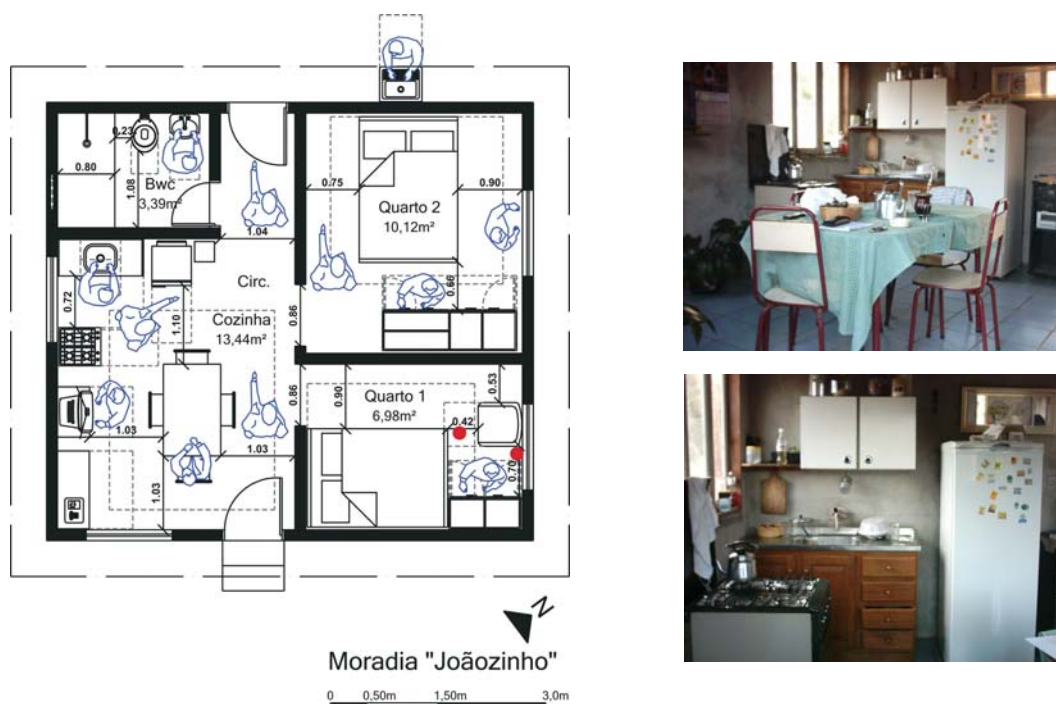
Arranjo do mobiliário da moradia "Joãozinho" em planta e fotos da cozinha
